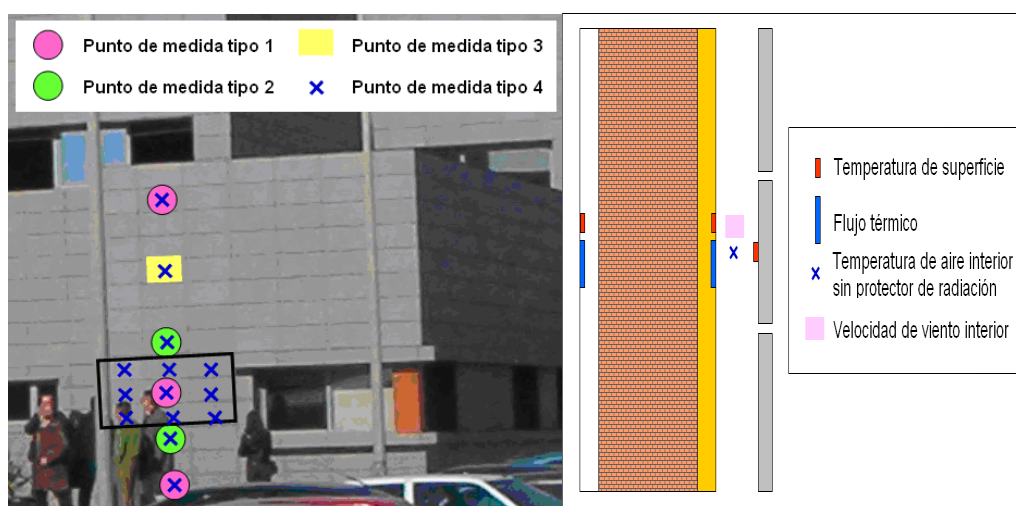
Distribución de sensores en la fachada ventilada. Vista exterior y lateral
